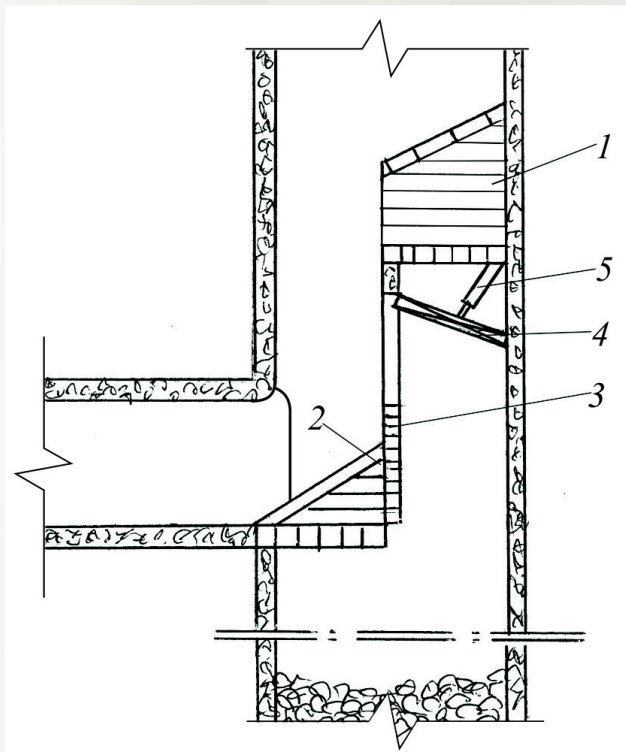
Клиновой предохранительный полок: 1, 2 — верхний и нижний полок с наклонными отражательными стенками; 3 — соединительная стенка; 4 — крышка окна; 5 — гидродомкрат
